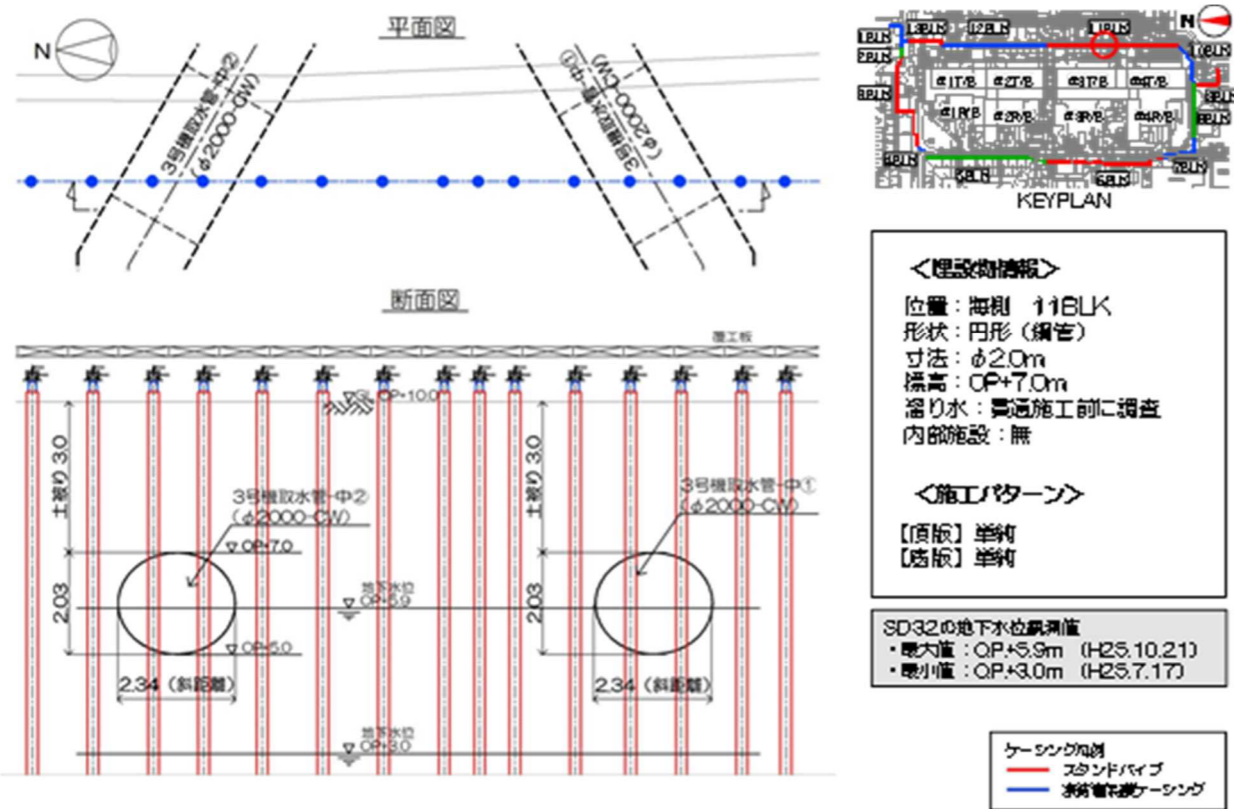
【11-11】3号機取水管-中①② 施工方法 (貫通施工)
